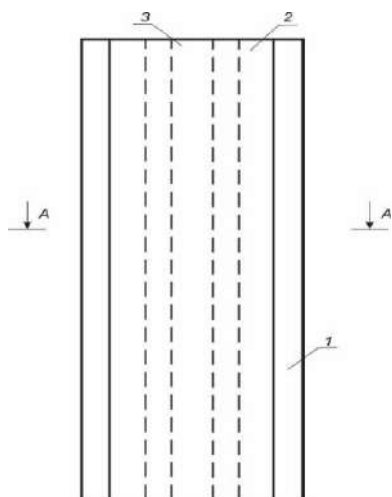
Фундамент высотных зданий с сооружений, возводимых на просадочных грунтах.
